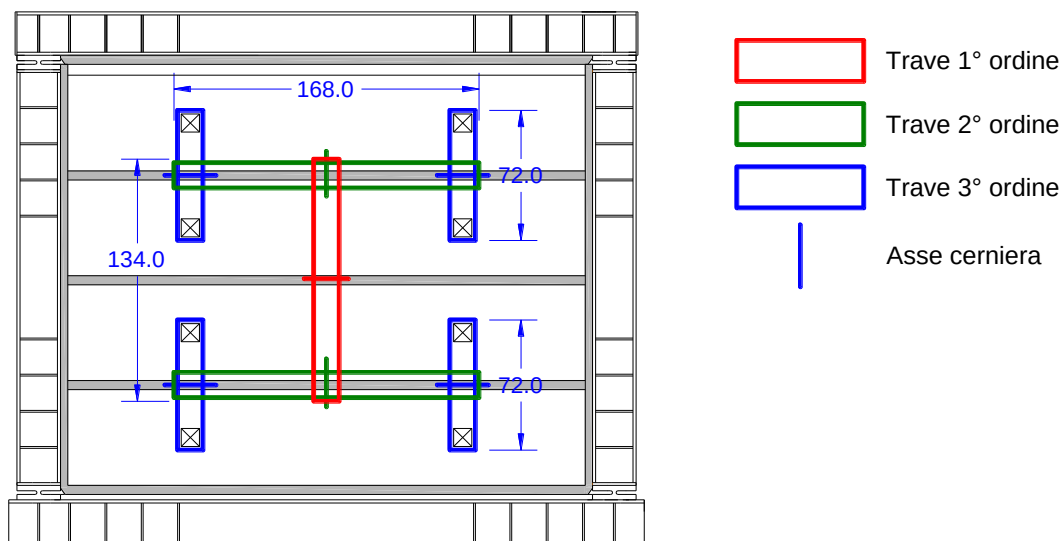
Disposizione delle travi nella prova con giunti orizzontali [cm]
